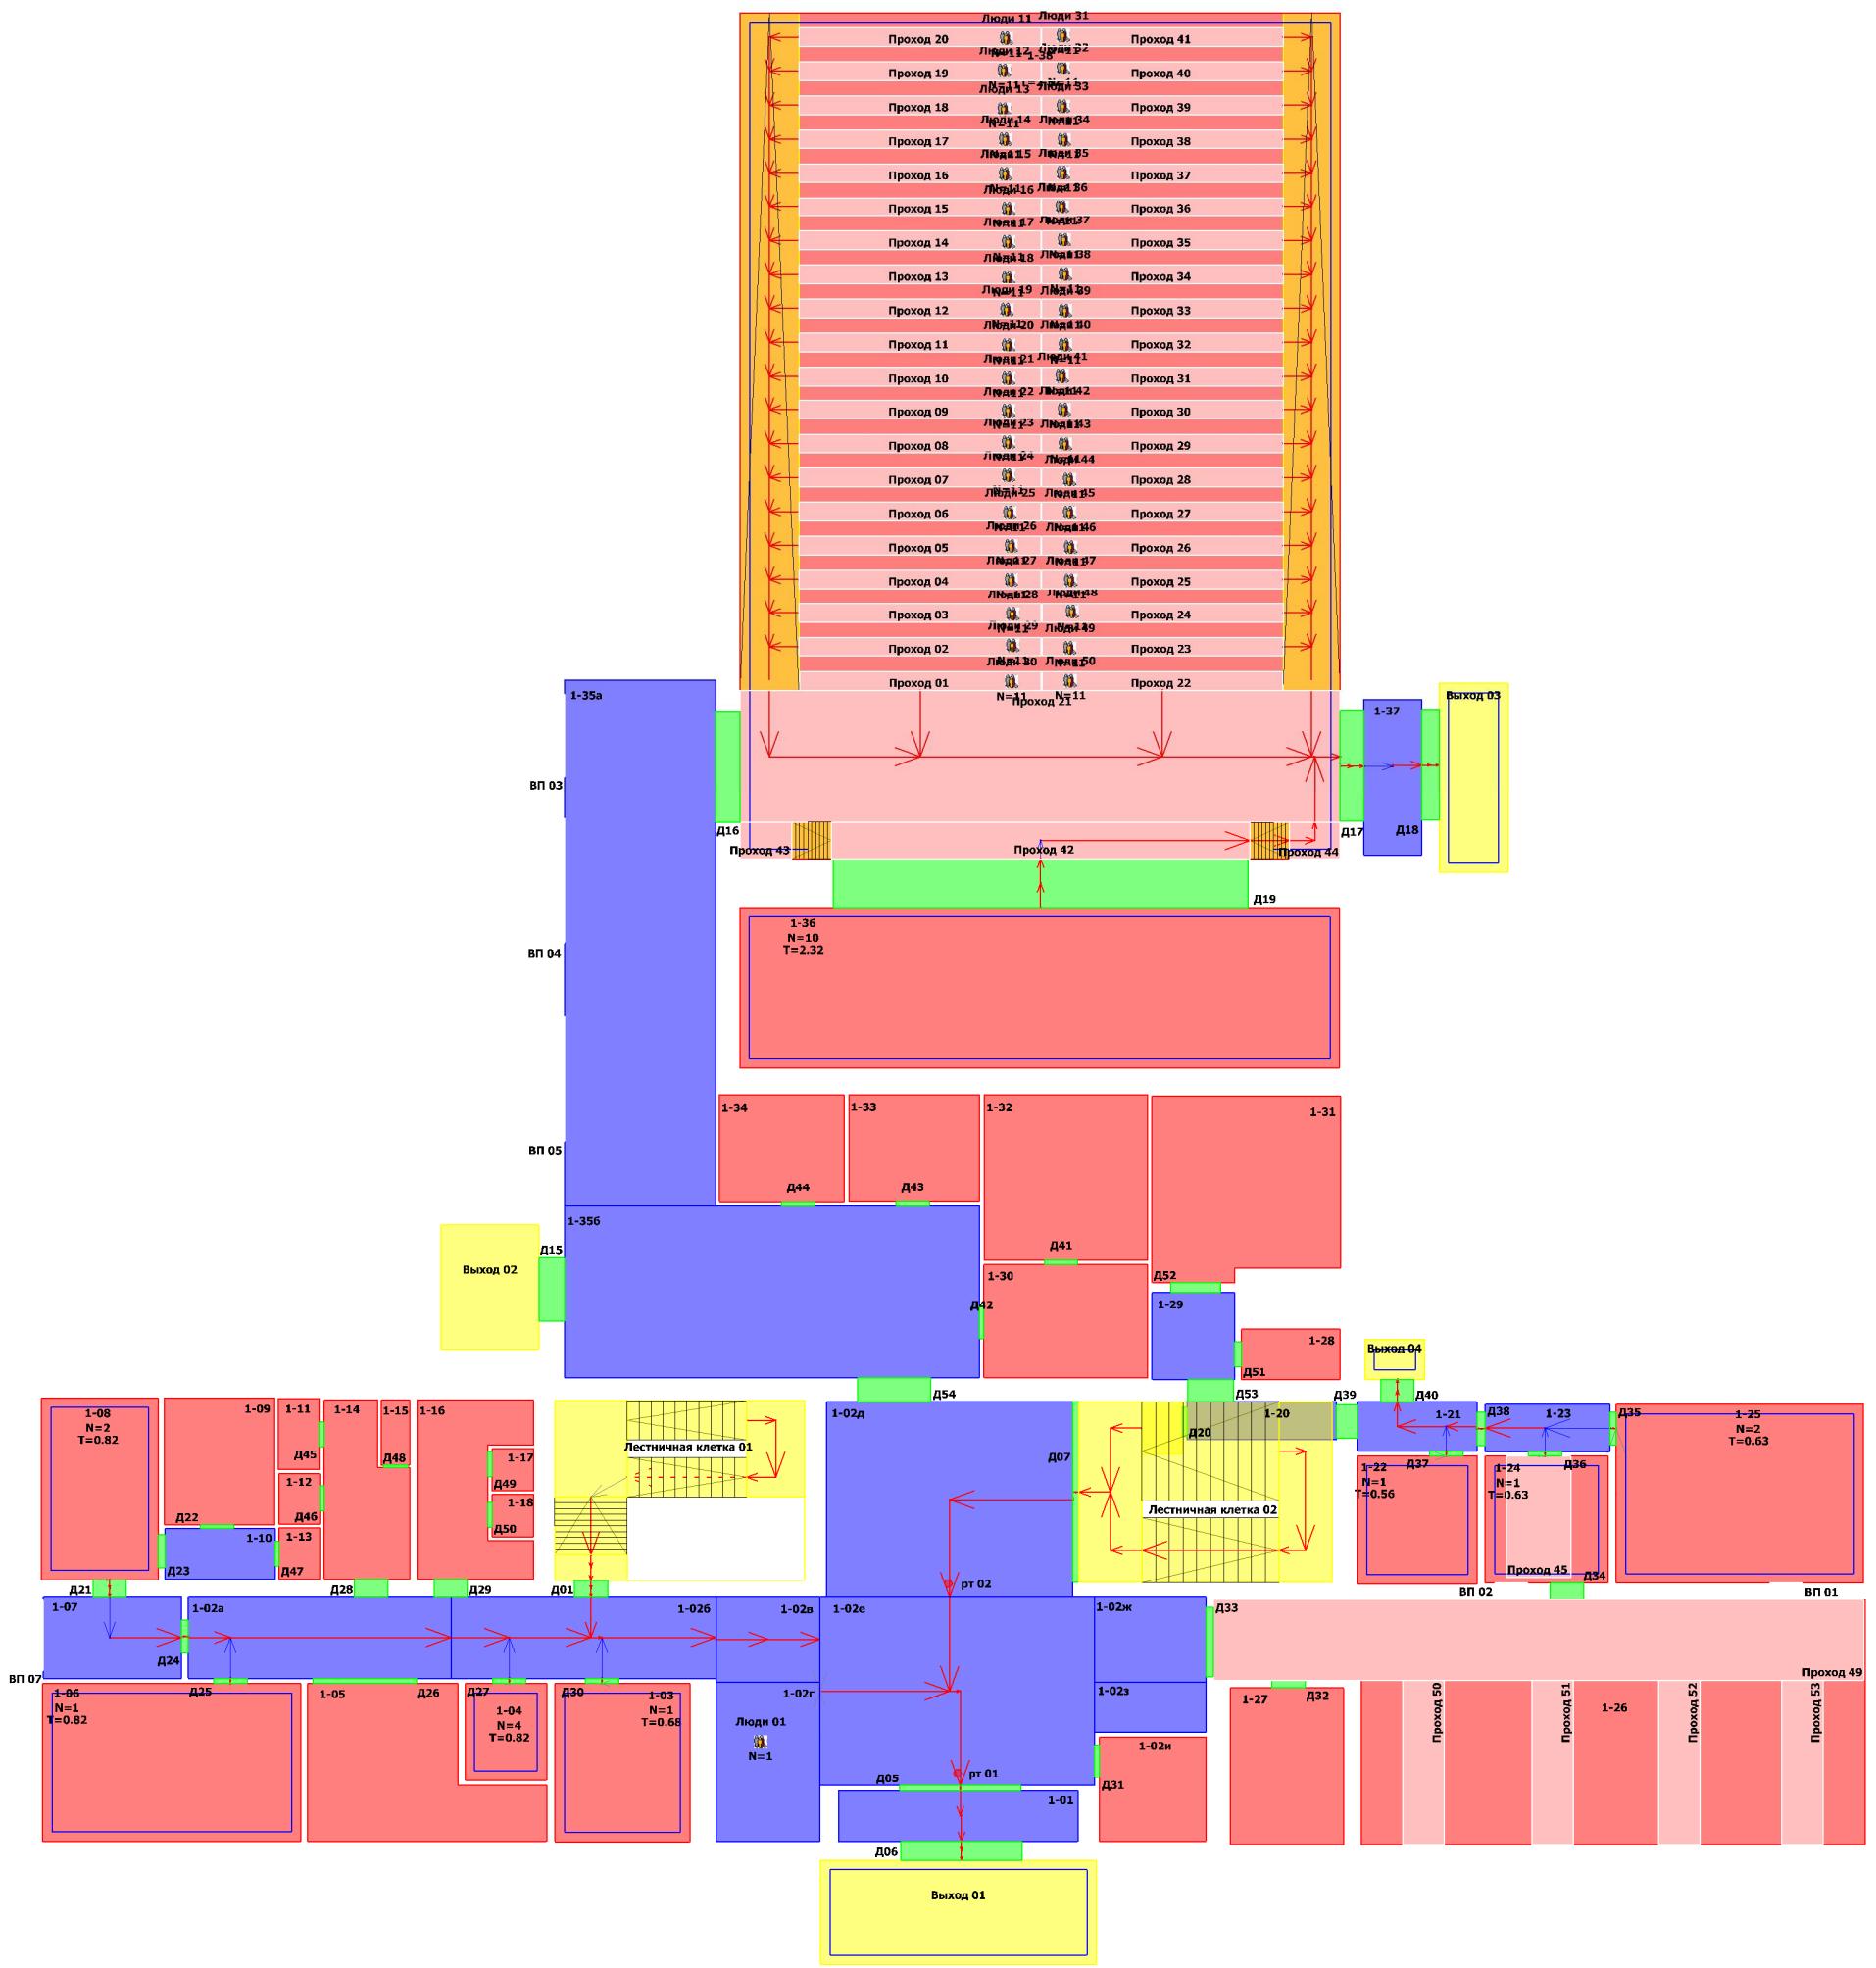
Расчетная схема эвакуации из помещений 1-го этажа здания Администрации
